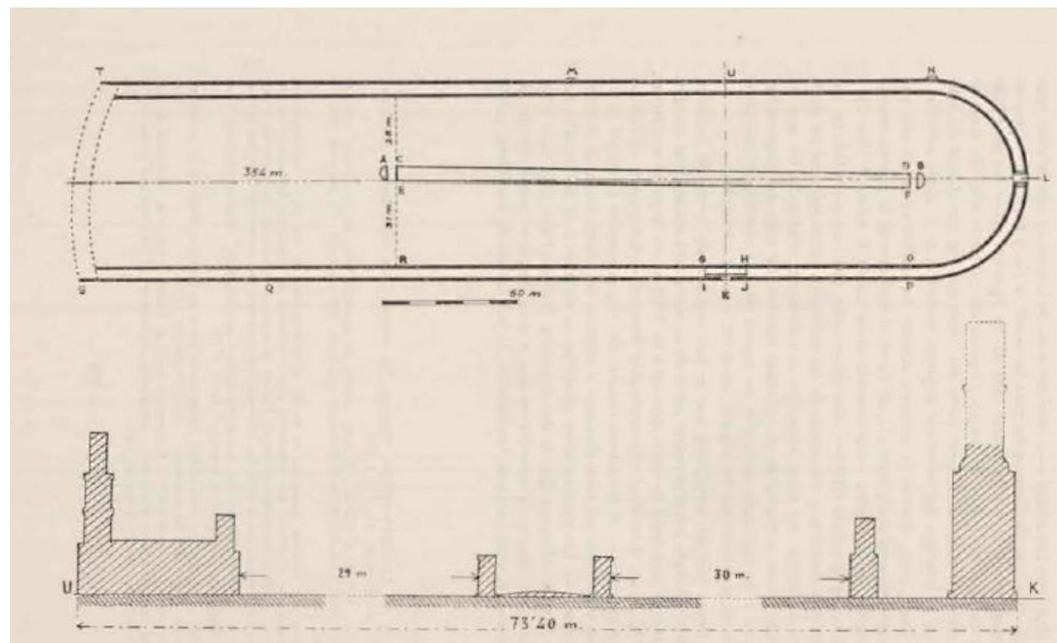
Reconstrucción de la planta del circo. (Bru, 1963: 204)
